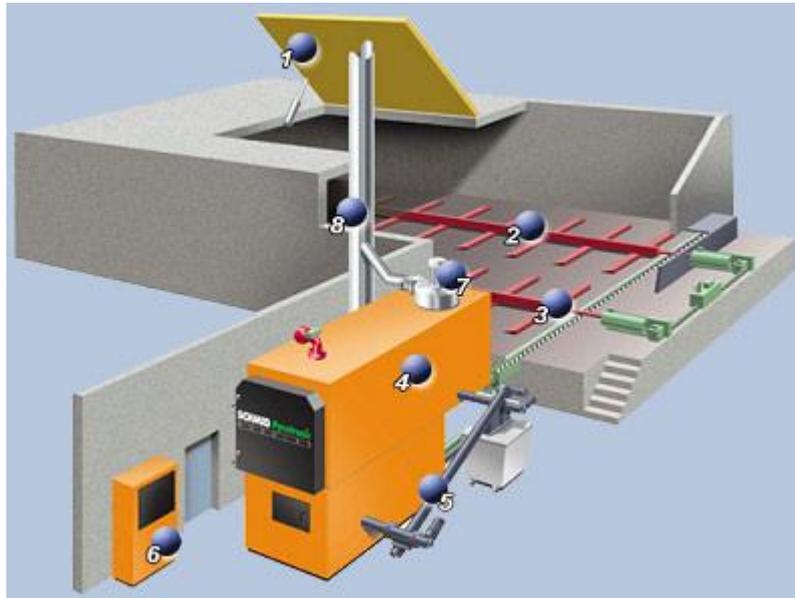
Silo de almacenamiento de obra civil con suelo horizontal (Suelo móvil)
